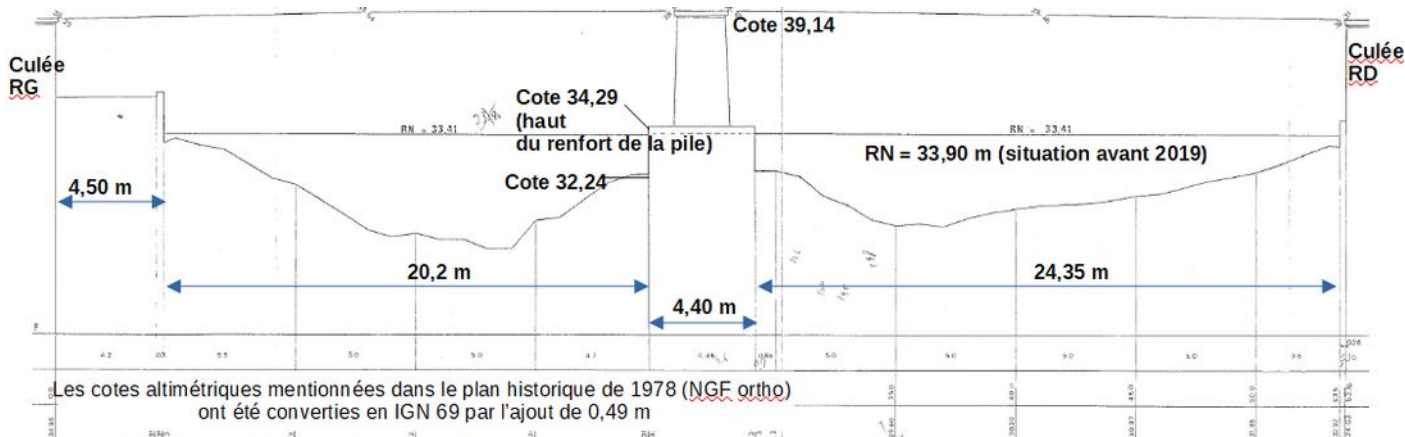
Plan du pont, caractéristiques dimensionnelles - plan établi en 1978
